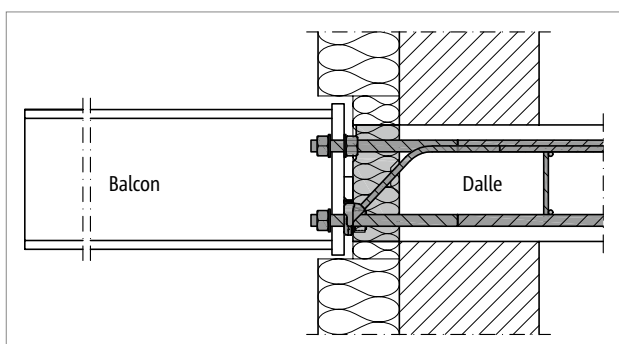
Schöck Isokorb® T type SK : raccordement à la dalle en béton armé ; corps isolant à l'intérieur de l'isolation thermique extérieure
